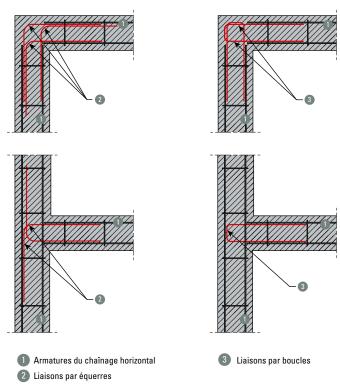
Exemple de liaisons entre armatures de chaînages horizontaux – Disposition correcte
